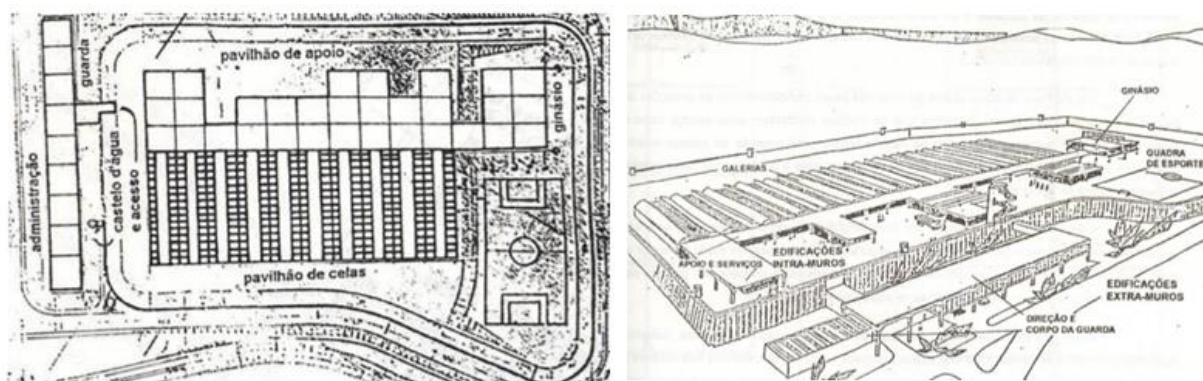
Planta esquemática e Perspectiva - projeto original de Bangu I
